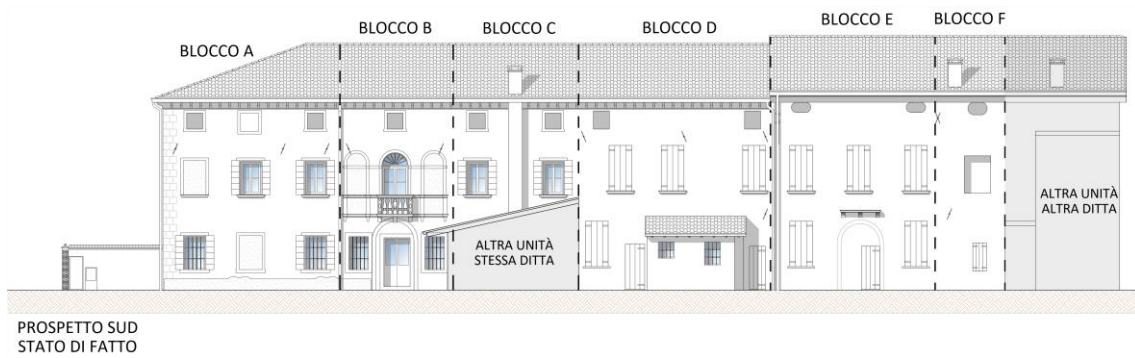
Prospetto Sud - Stato di fatto – scala generica
